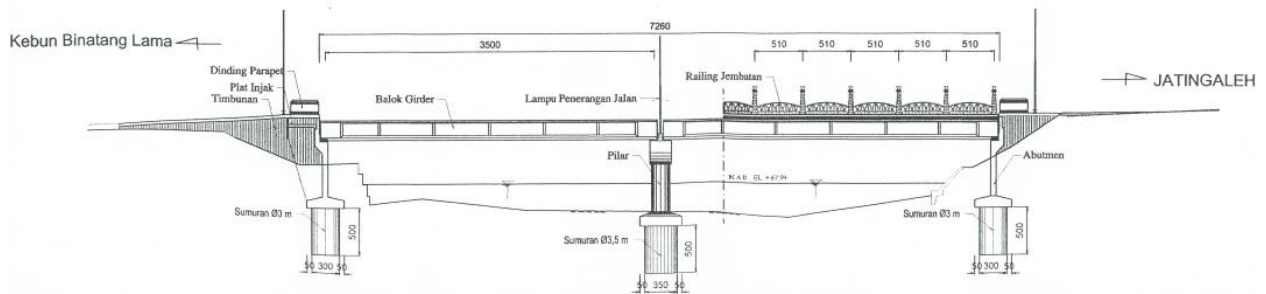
Denah Struktur Jembatan Tinjomoyo
